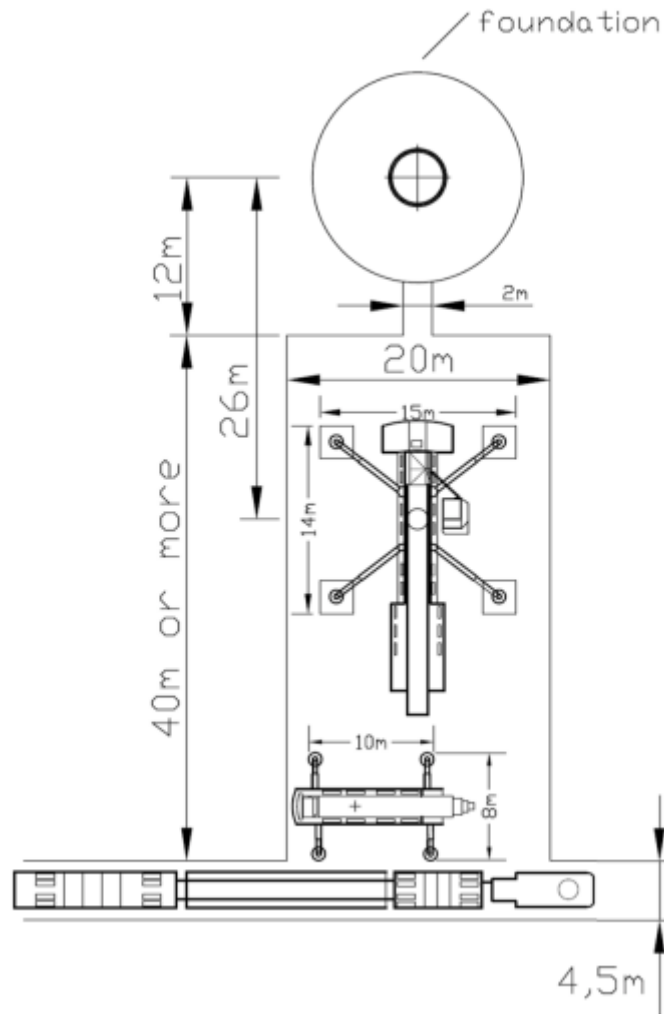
Exemple d'une plateforme de grutage (sources : General Electric)
